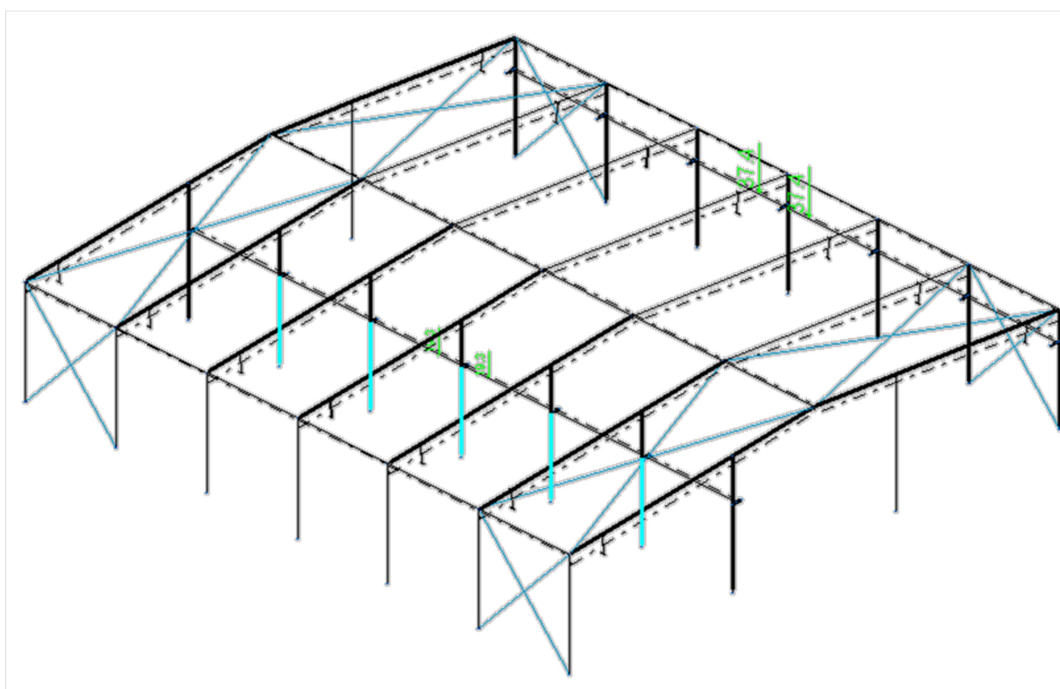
Cargas del puente grúa para el cálculo de la estructura
